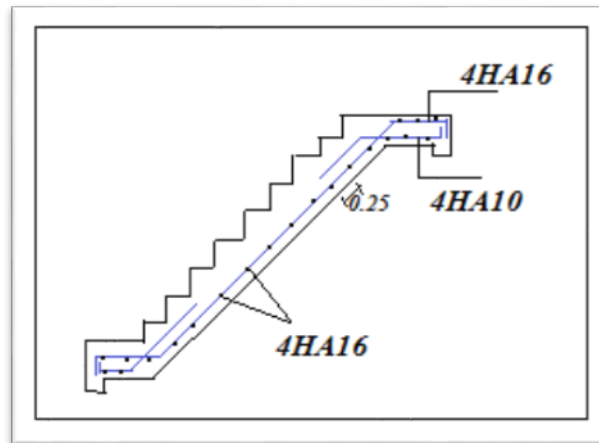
schéma de ferrailage d'escalier l'autres étages type 01 du volée 01
